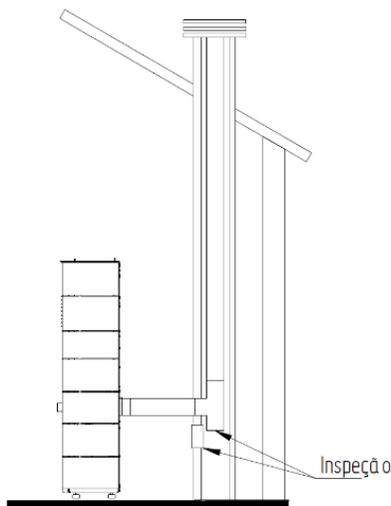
Vista lateral da instalação com chaminé, com exemplo do ponto de inspeção.
